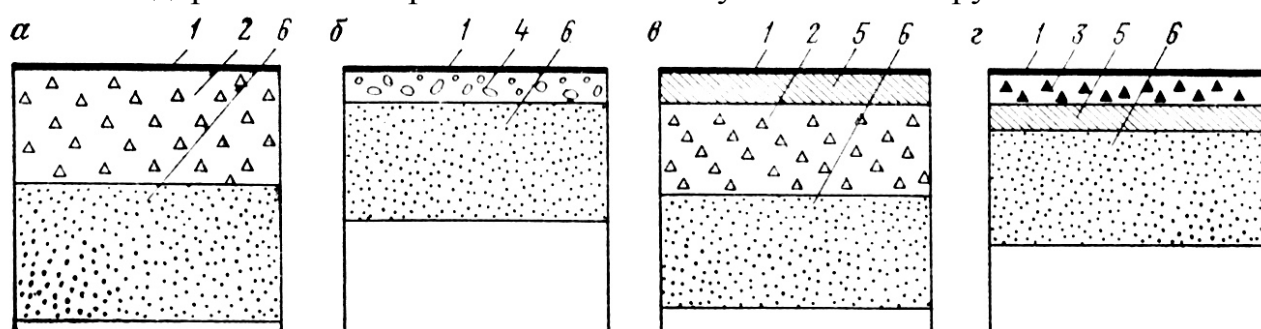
Конструкции дорожных покрытий промышленных автодорог:
